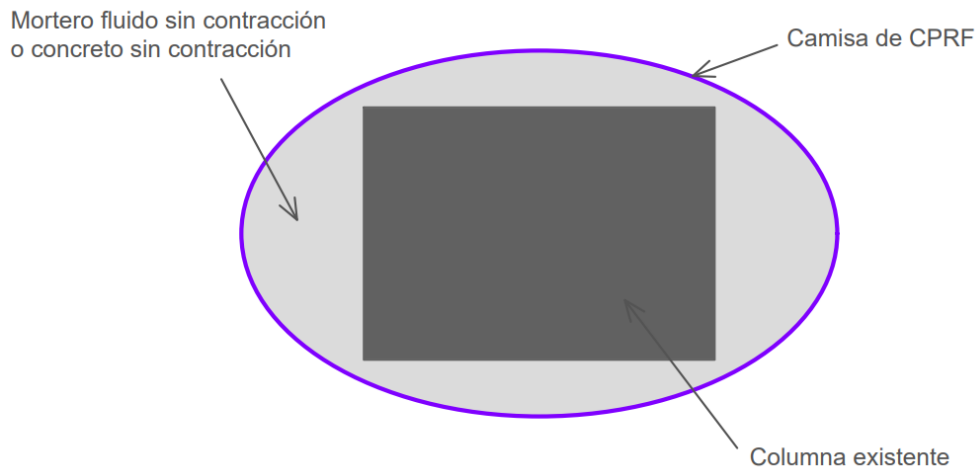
Ejemplo de modificación de una columna con sección transversal rectangular a una con sección transversal ovalada mediante un encamisado de CPRF
